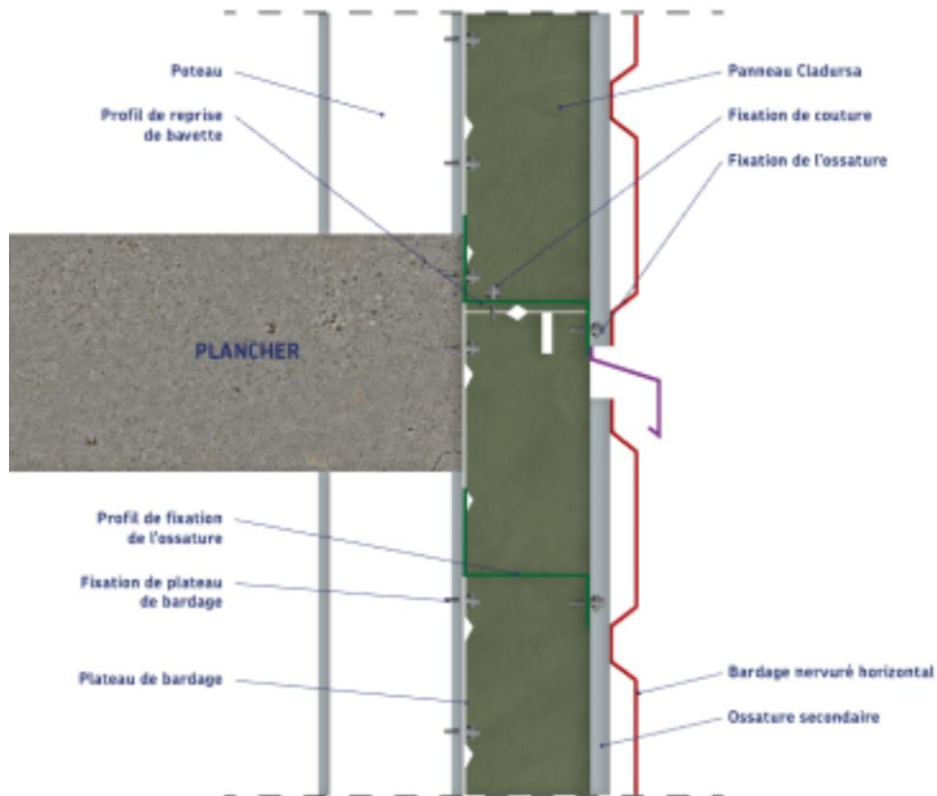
Exemple d'interruption au droit d'un plancher en zones sismiques
